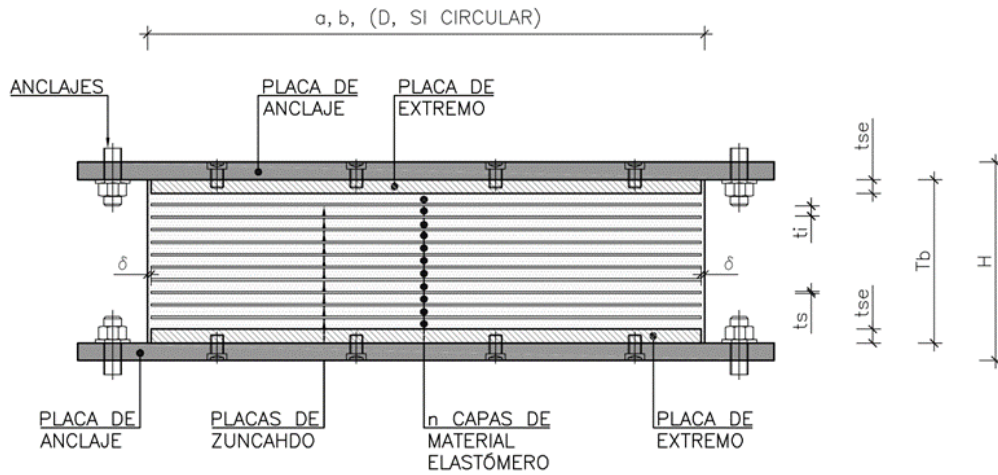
Alzado tipo de aislador elastomérico LDRB normalizado con unión atornillada de las placas de extremo a las placas de anclaje
